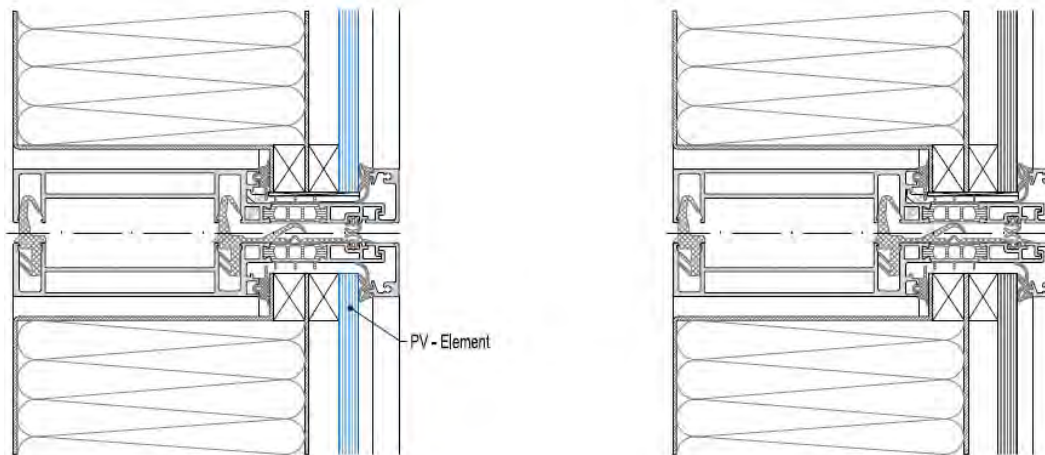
Elementfassade einschalig mit und ohne PV-Element (PFEILER 2009)
